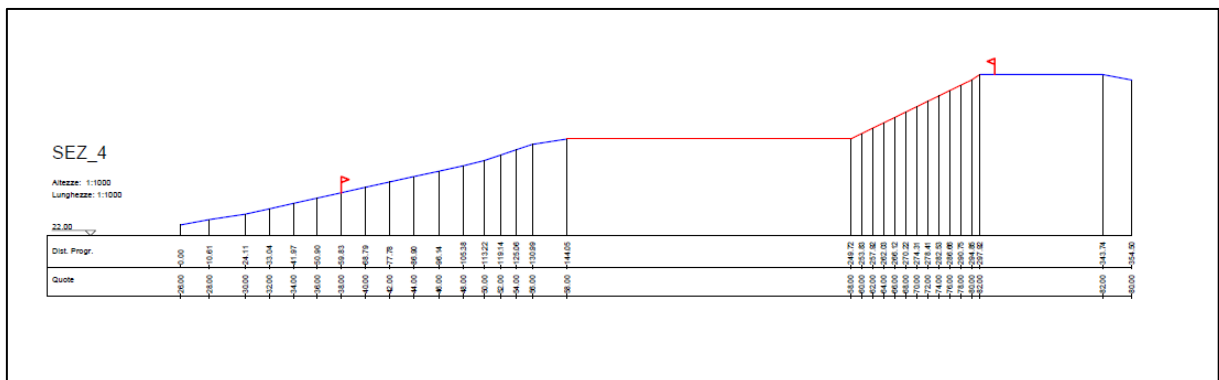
Schema rappresentante sezione di scavo nel primo stadio di coltivazione
